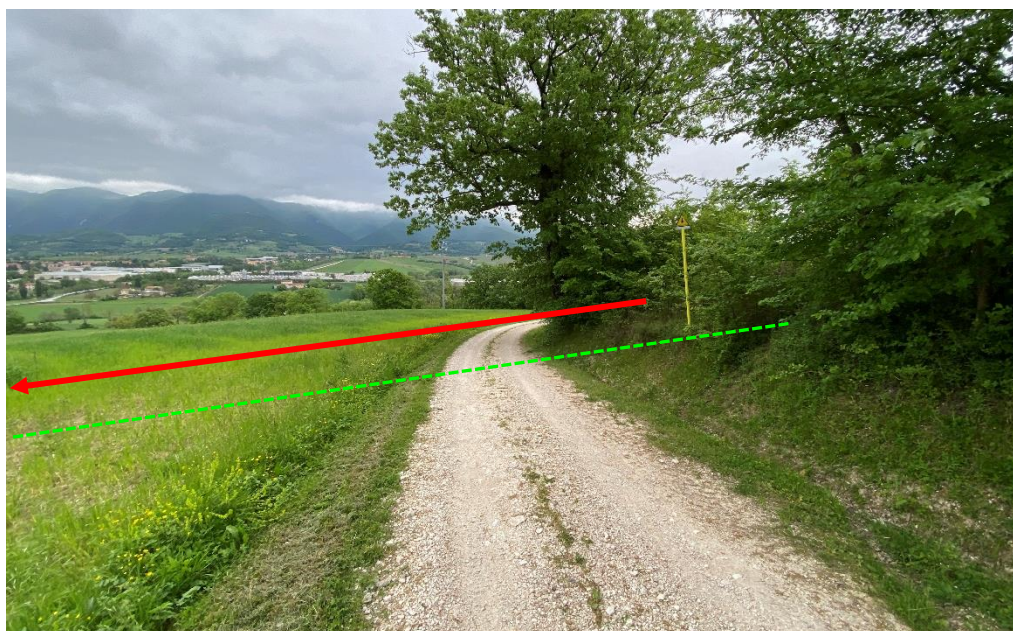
attraversamento strada “Variante 1 su Diramazione Per Cerreto d’Esì in comune di Cerreto d’Esì DN200(8”) DP 75 bar”
